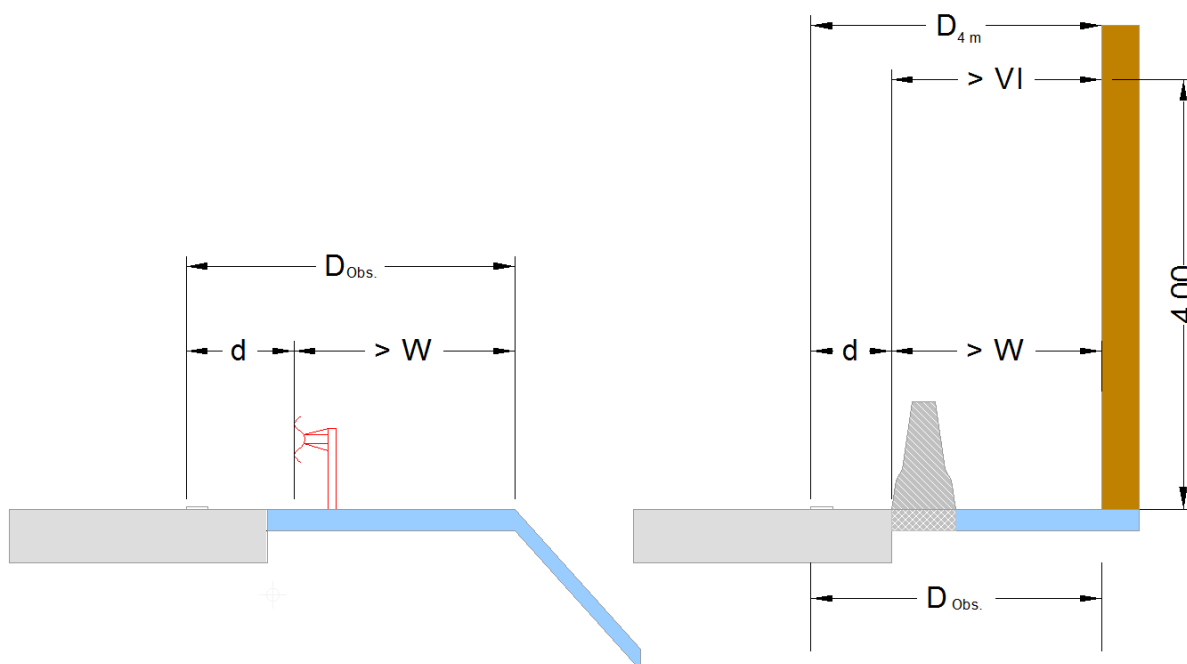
Exemples de distance d'implantation d'un dispositif de retenue en accotement.
